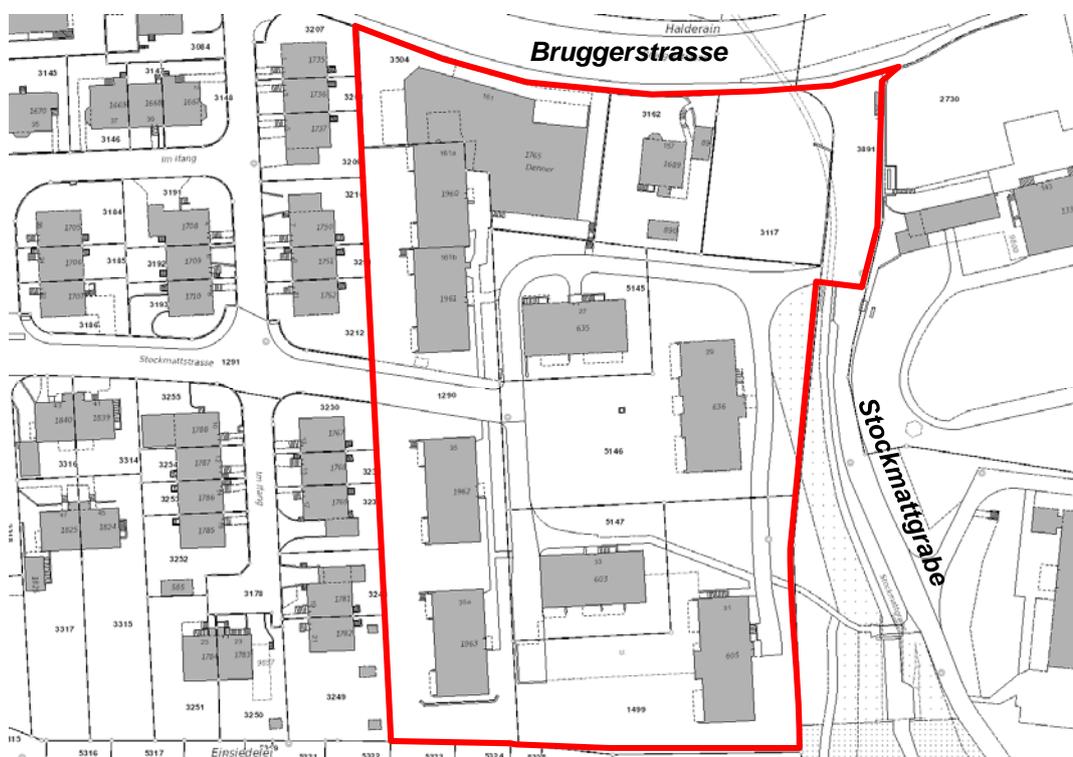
Situationsplan mit Perimeter Gestaltungsplan
